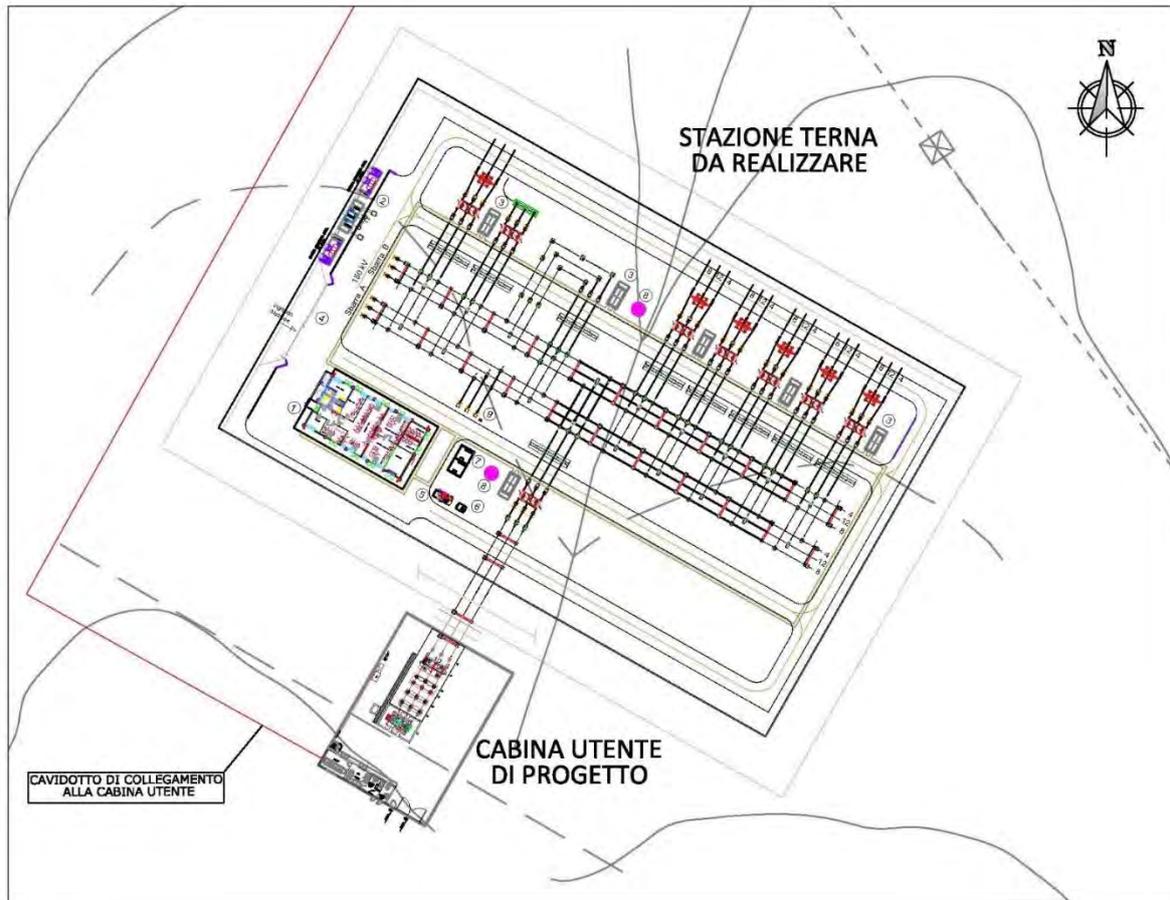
Planimetria cabina utente 30/150 kV – Collegamento in aereo
